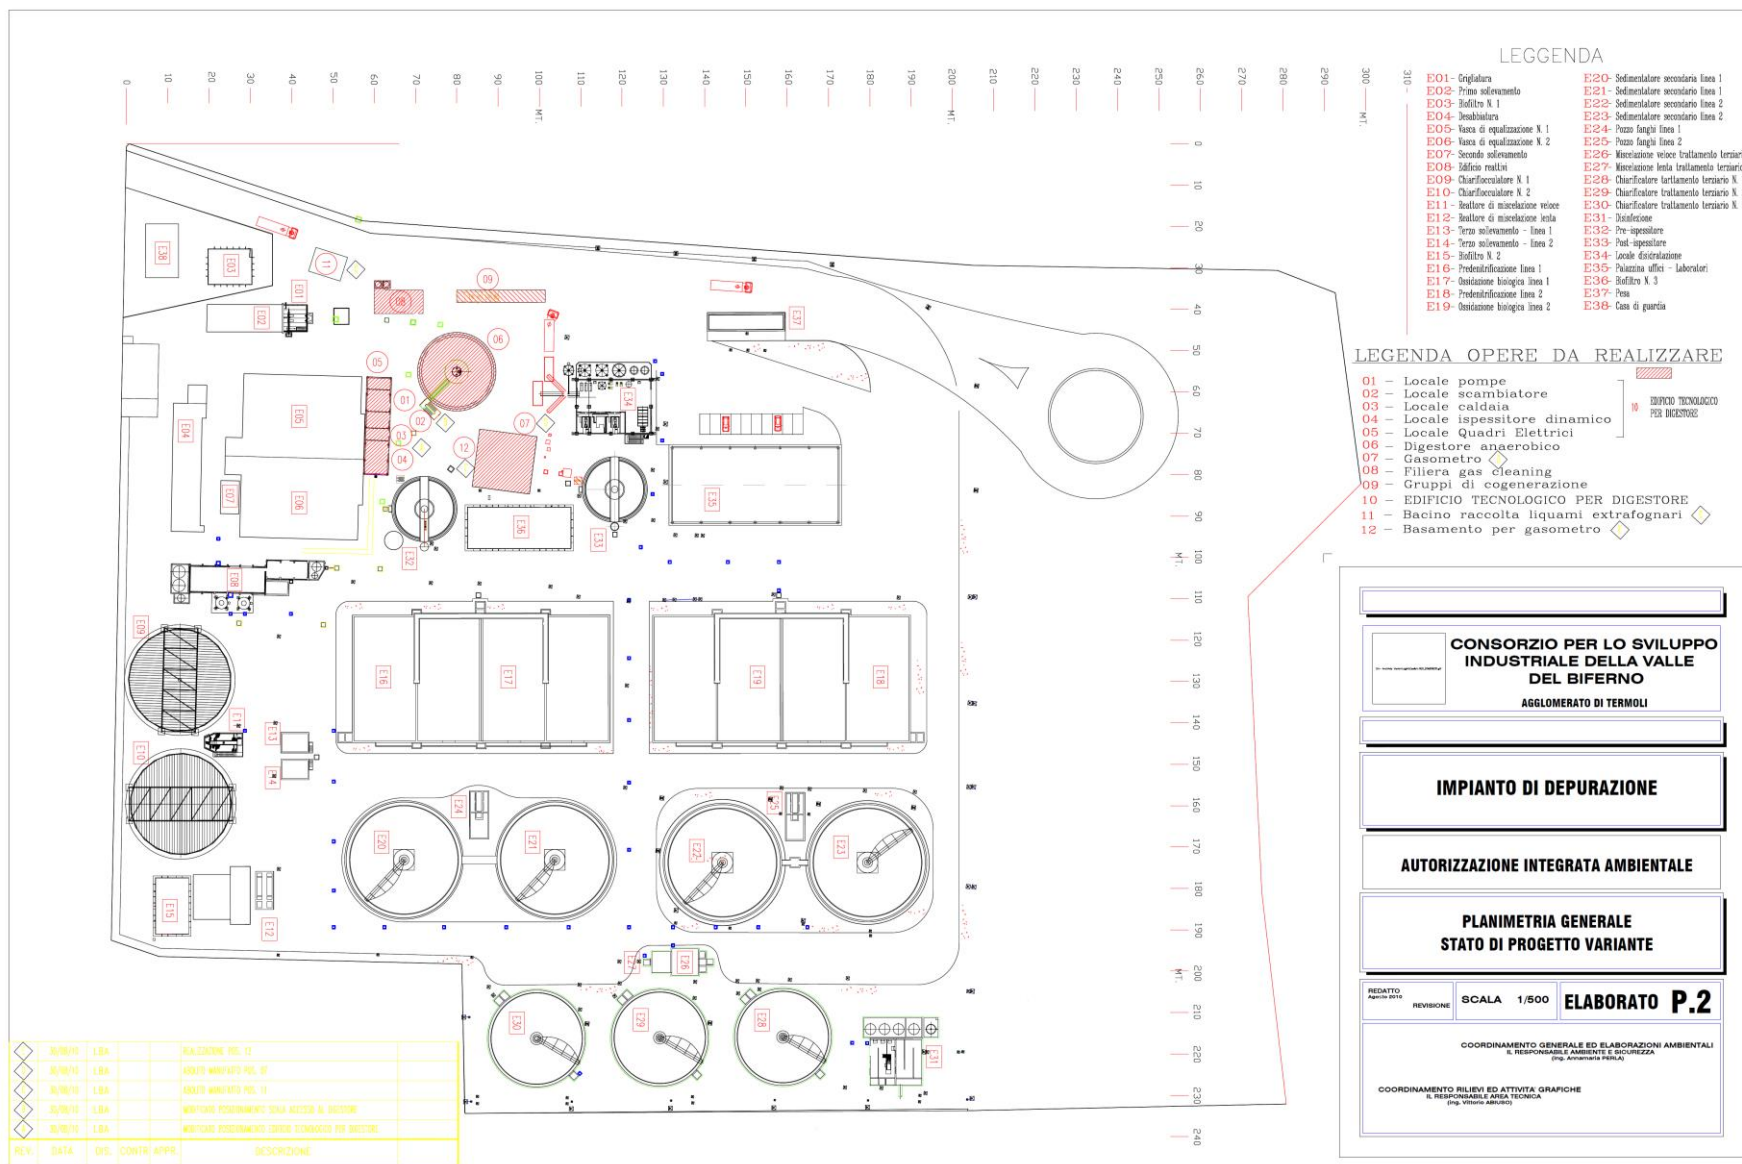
planimetria generale dell'impianto: stato di progetto
